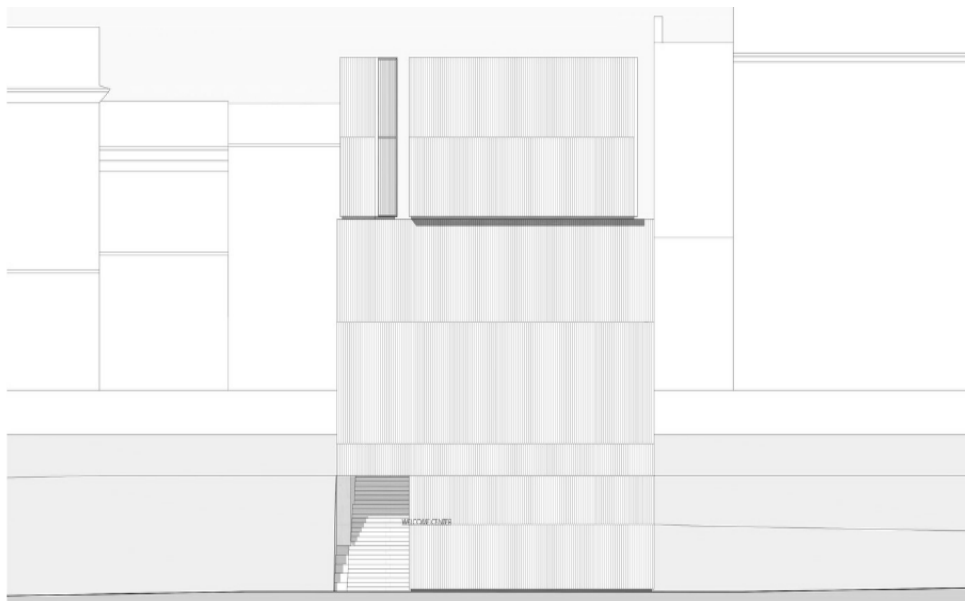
Corte transversal B. Fuente: Archdaily (2018).
